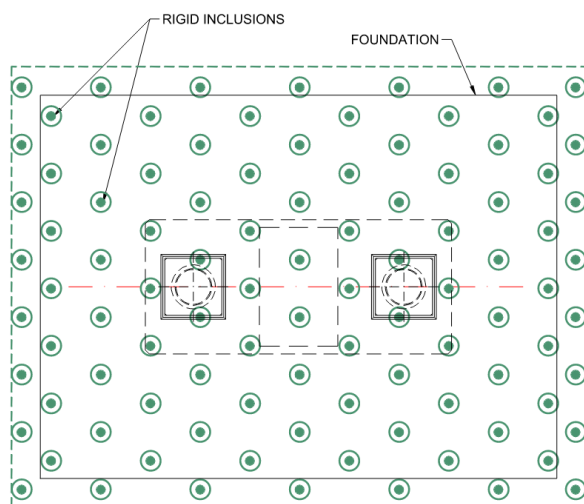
Mejora del terreno bajo las cimentaciones de las pilas. Planta.
